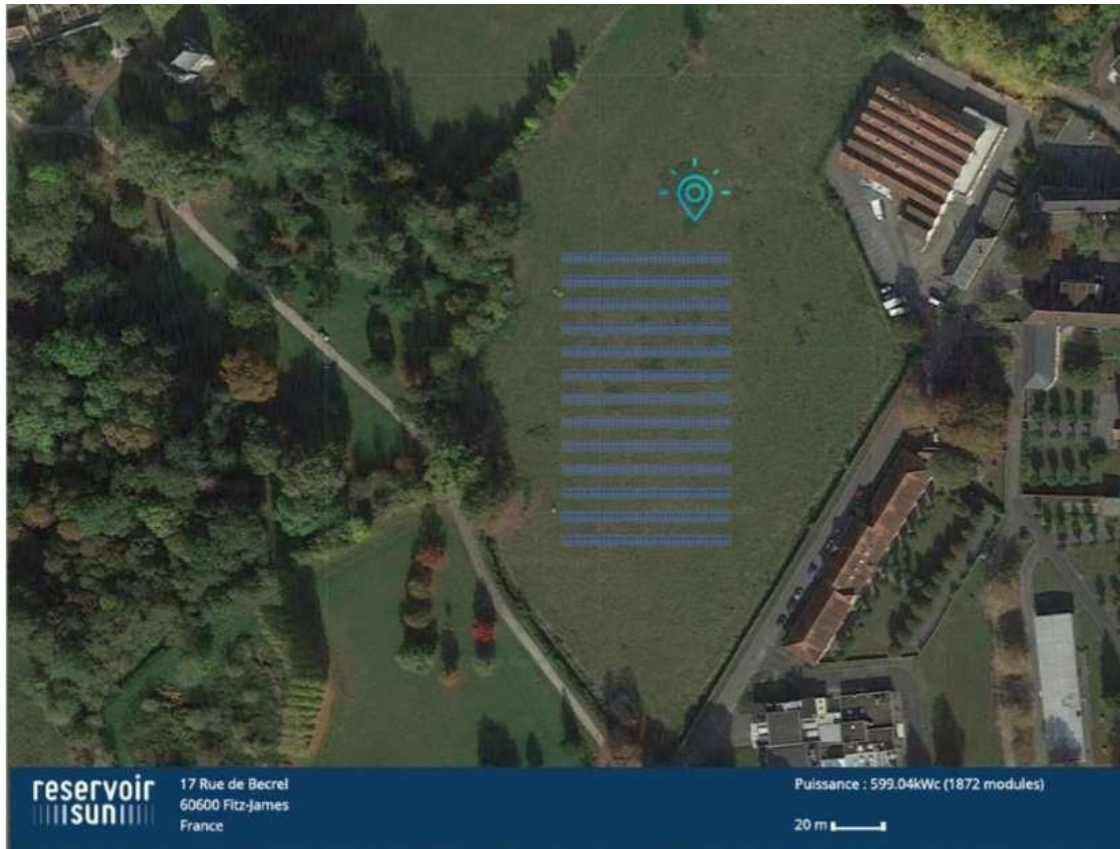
Plan prévisionnel d'implantation des panneaux solaires.
